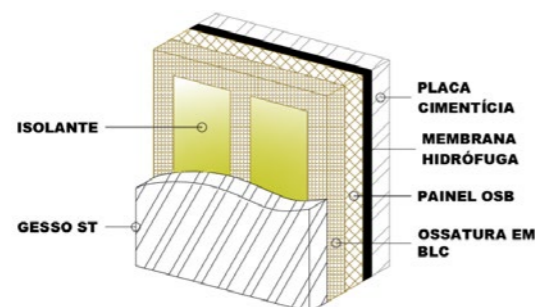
Vedação com placa cimentícia e gesso ST. Fonte: elaborado pelos autores.
